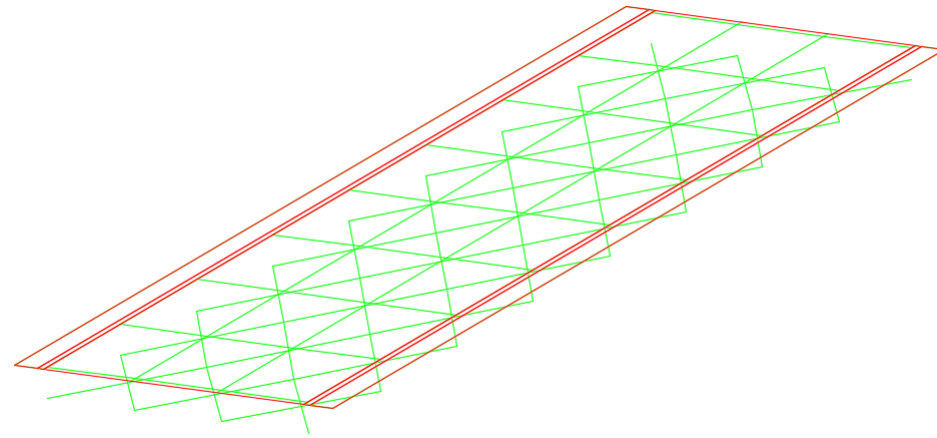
Vista 3D de plano para SAP2000. Elaboración propia con AutoCad.
